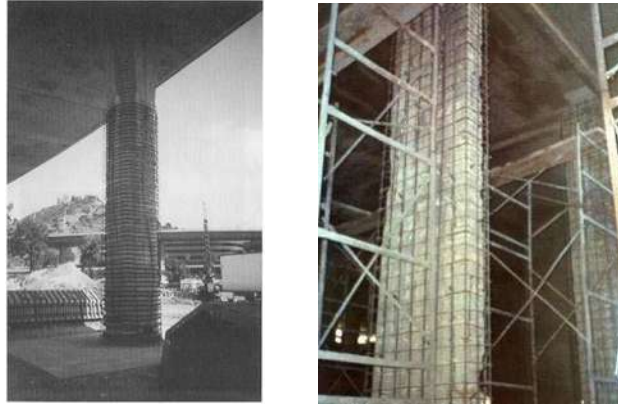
Armado de acero longitudinal y transversal en las columnas que serán encamisadas.
